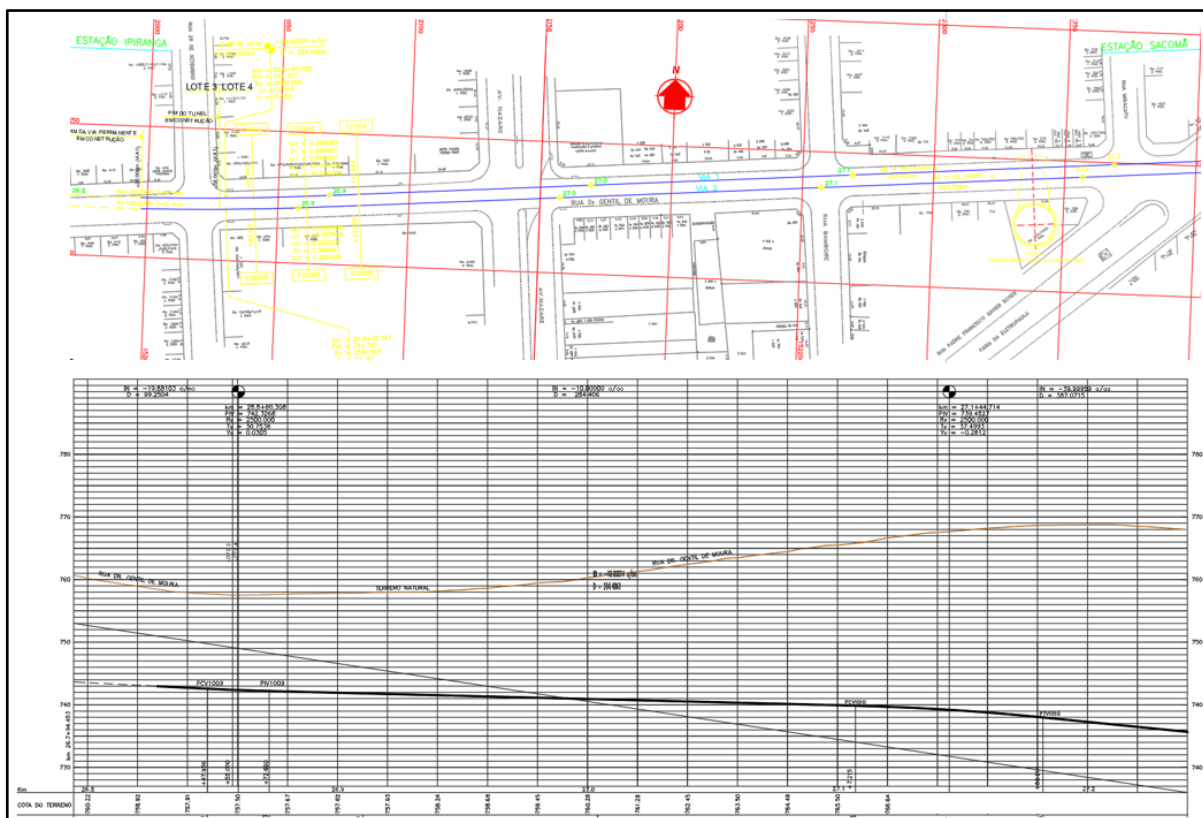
Planta e elevação do trecho de interesse (Maffei Engenharia)
